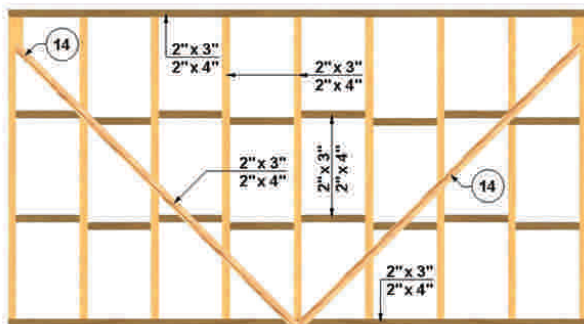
20: Muro arriostrado por medio de diagonales estructurales, de igual escuadría que las piezas principales, pieza N° 14.
